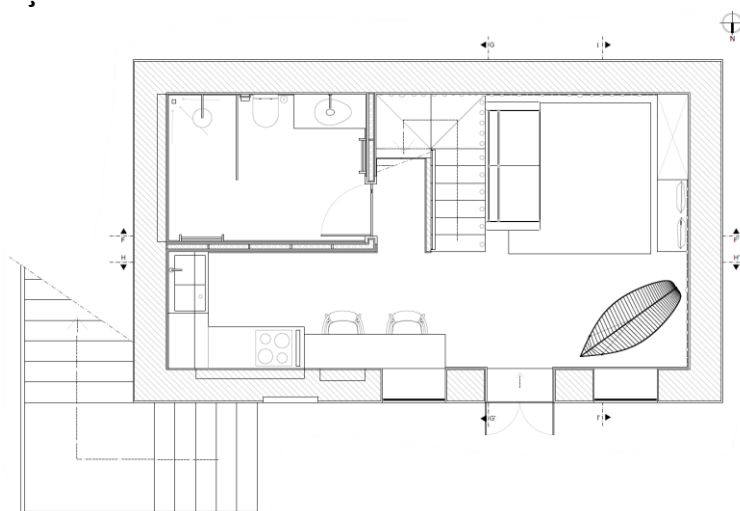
Pormenorização, Alojamento Til, R/Chão.
